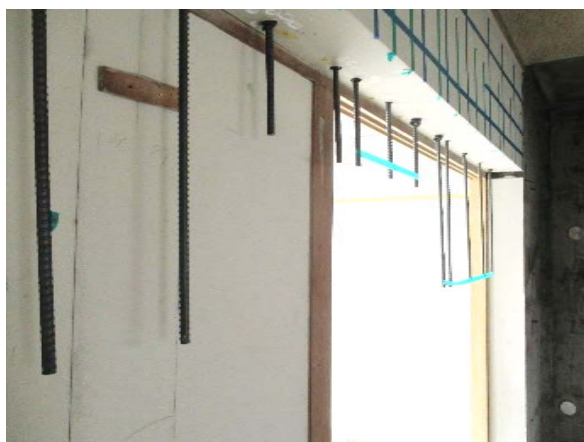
施工状況(302号室壁梁・上向き)
